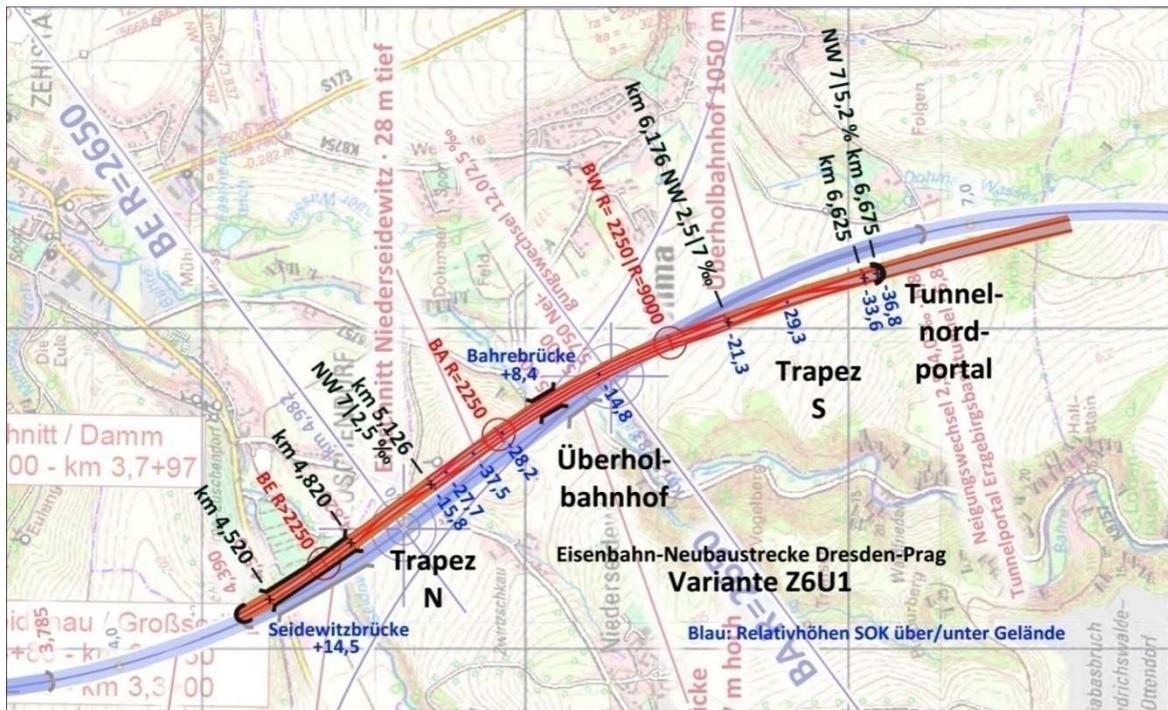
Grundriss Z6U1 (rot). Hintergrund: Grundriss Z6 (hellblau).
